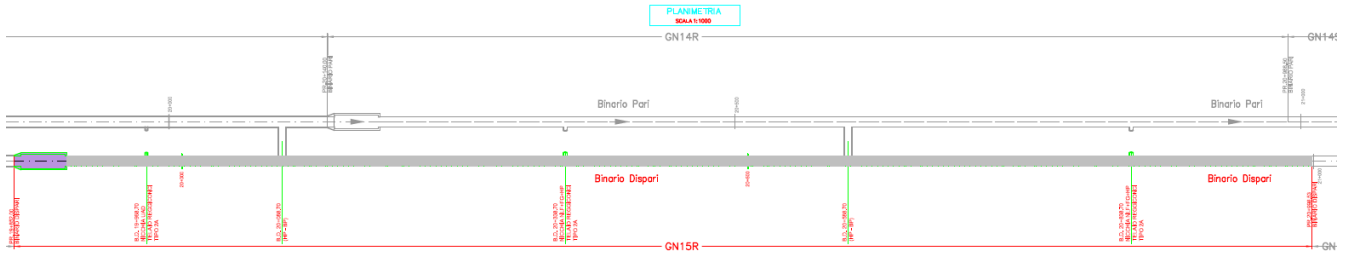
Planimetria scavo meccanizzato – WBS GN15R
